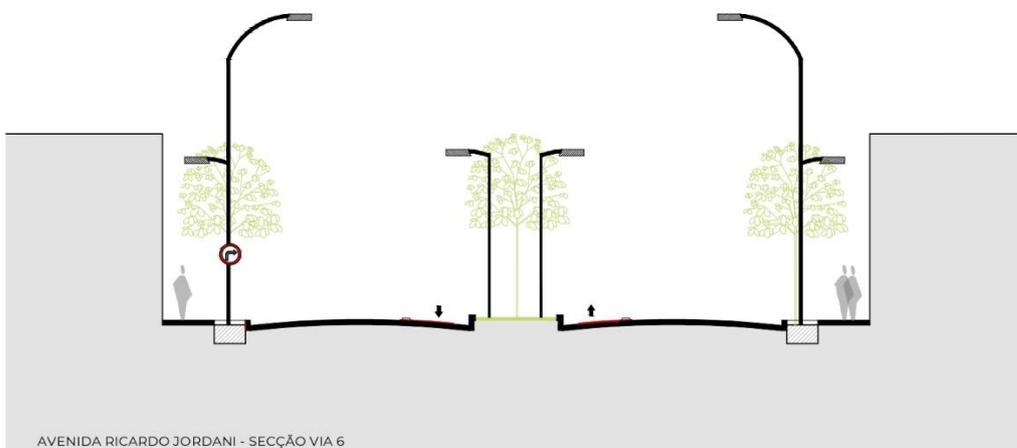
Corte esquemático da Avenida Ricardo Jordani.
